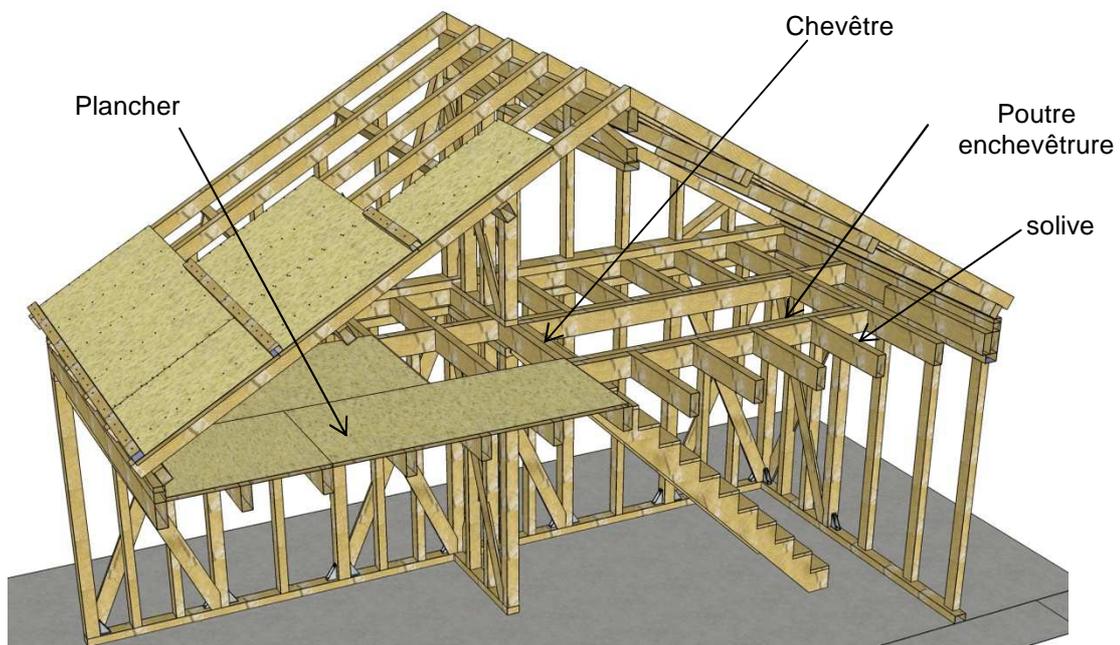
Schéma de principe constructif d'un plancher bois (Perspective)
